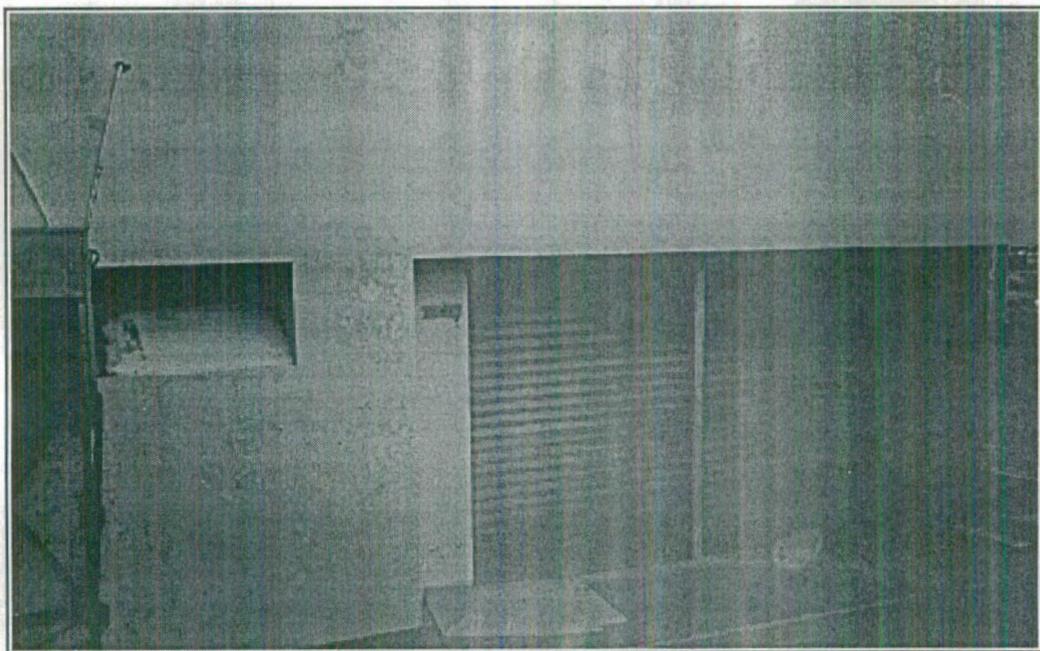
Reubicación de divisiones interiores en sección Contabilidad Area de Apoyo Administrativo.
